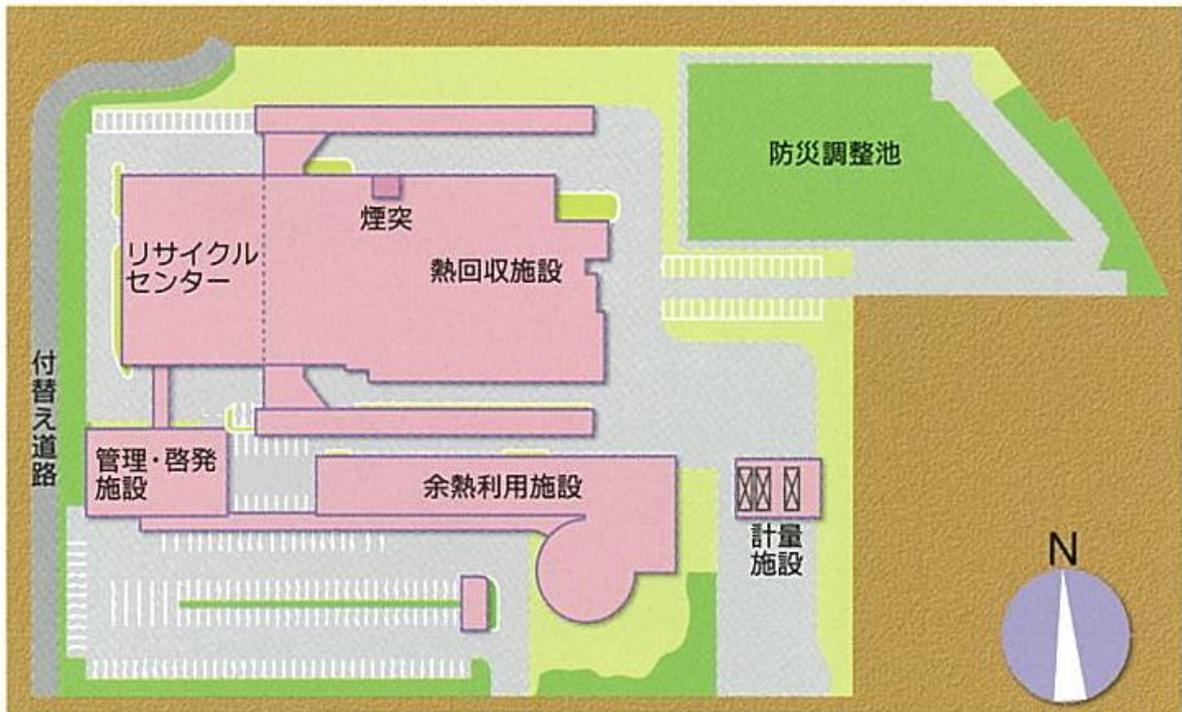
ごみ焼却施設と周辺施設の配置図
